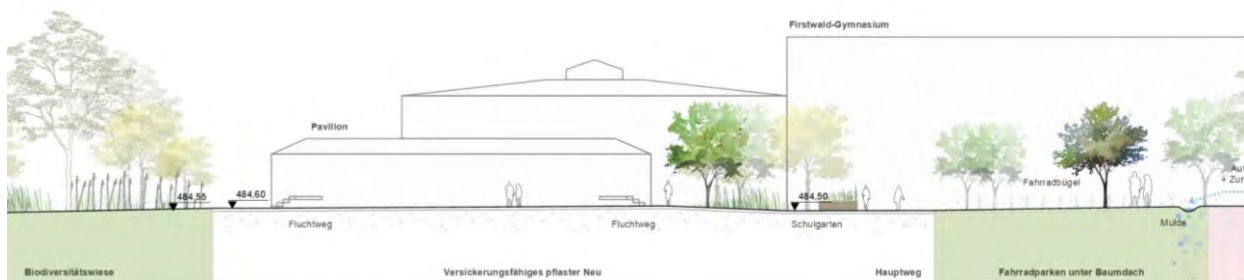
Planausschnitt Vorentwurf Bereich Pavillon (Anhang Plan 1.1), Schnitt (Anhang Plan 1.2) (faktorgruen, 2025)
